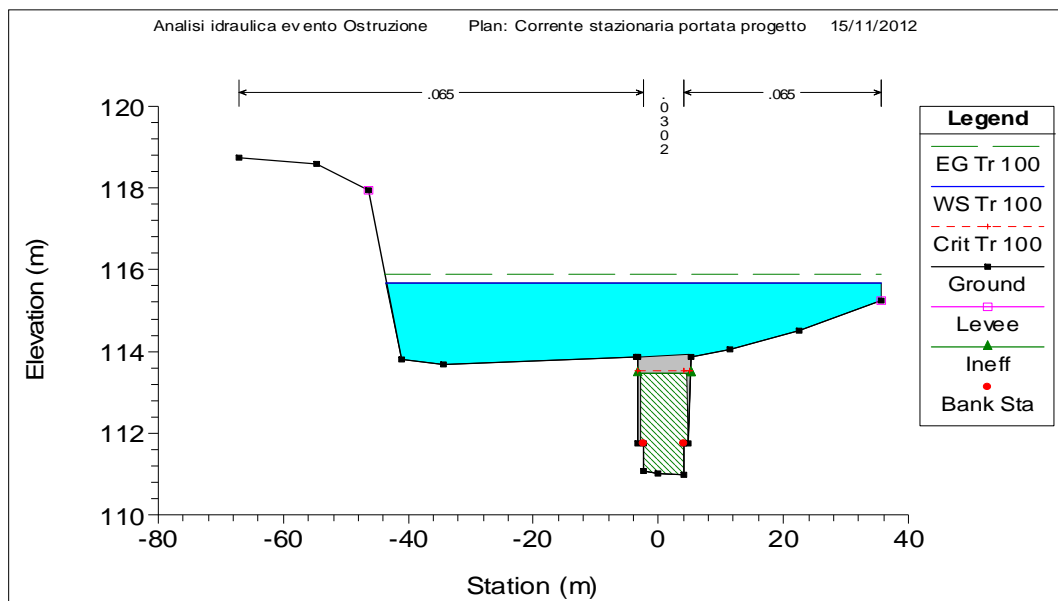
36 - Sezione n.23; lato monte del ponte 1km a valle dell'allevamento ittico in località "Tresana paese", alveo ricostruito.
